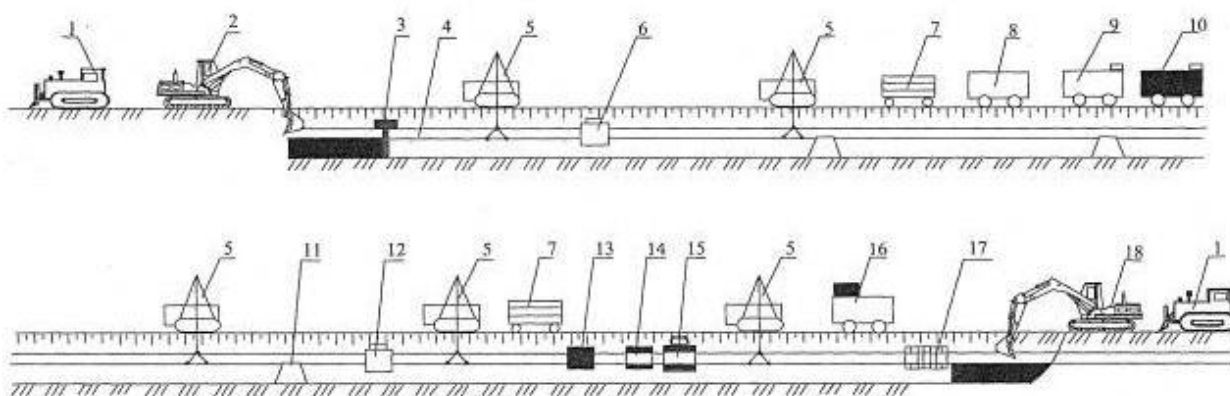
Схема капитального ремонта трубопровода в траншее
